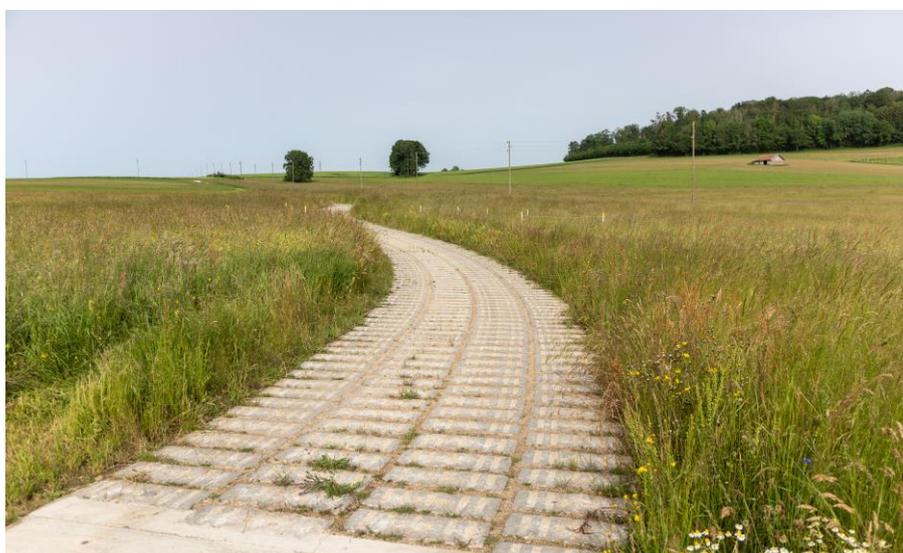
route drainante en plots de béton (photo : LIN'eco)
